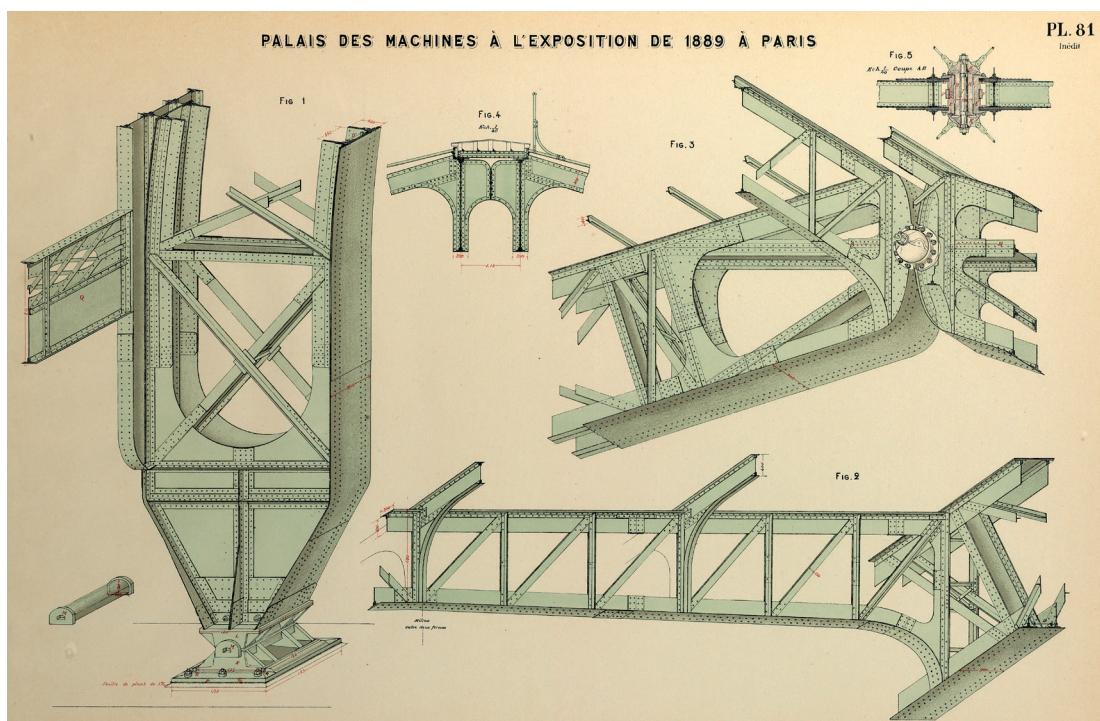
Galería de las Máquinas de 1889. Detalles de estructura.
